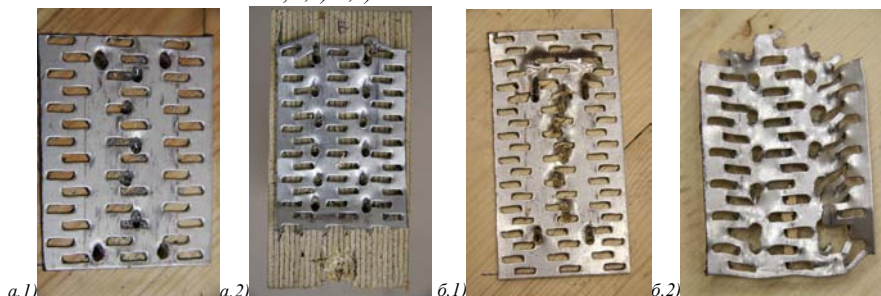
Виды разрушения МЗП в деревянных конструкциях: а,1)-а,2) стеновой панели и балки из *CLT*; б,1)-б,2) стеновой панели из *CLT* и балки из *LVL
